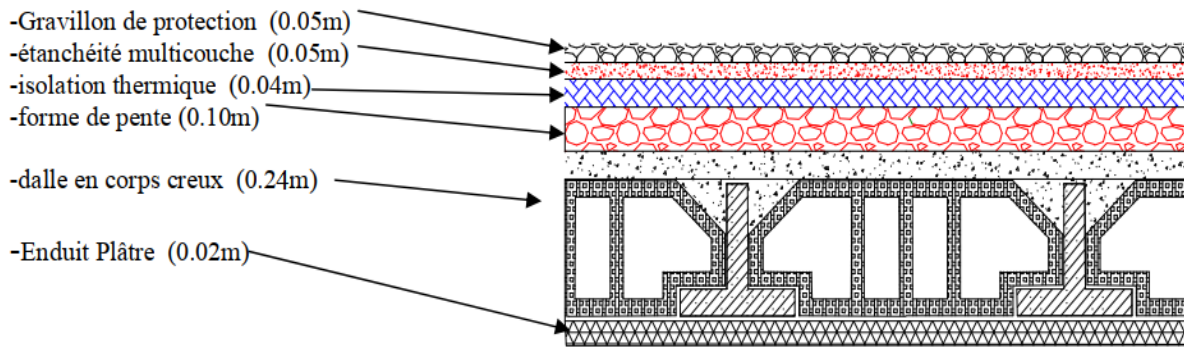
Schéma d'un plancher de terrasse inaccessible.
